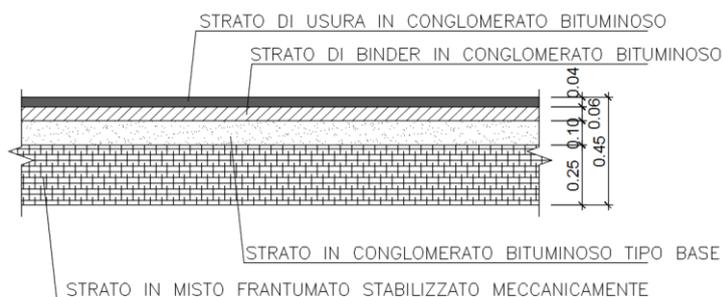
Pacchetto pavimentazione Strada E Urbana di quartiere
